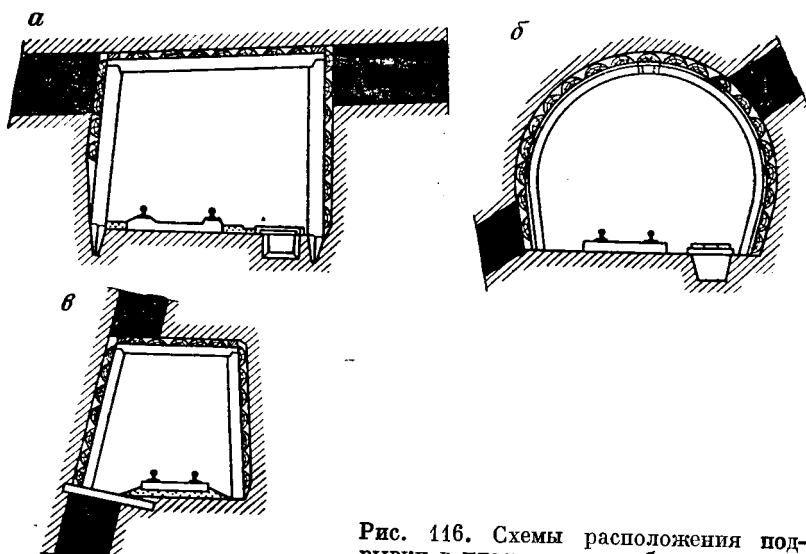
Схемы расположения подрыбки в пластовых выработках
